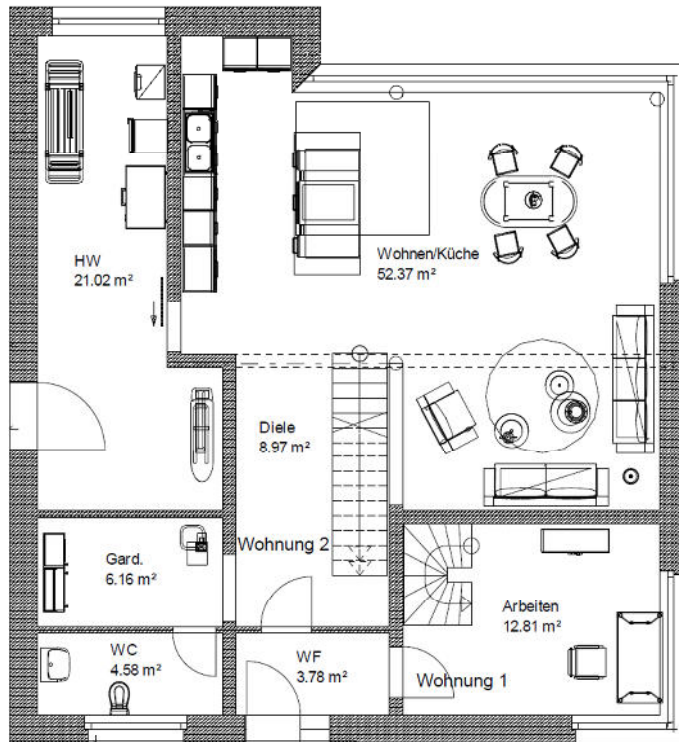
Grundriss Erdgeschoss
